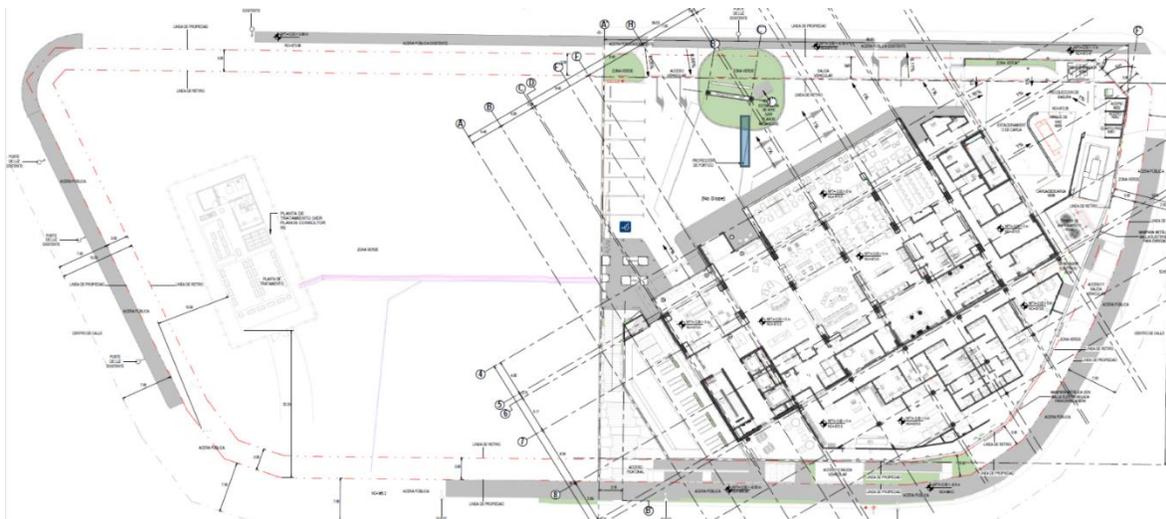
Planta de Conjunto. Proyección de Retiros de Construcción, 3.00 metros sobre sobre calle cantonal, lámina # AC-304 de los planos presentados.
